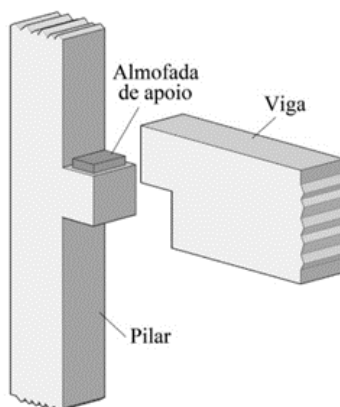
Ligação viga-pilar pré-moldada com dente e consolo de concreto. Fonte: El Debs (2017)
